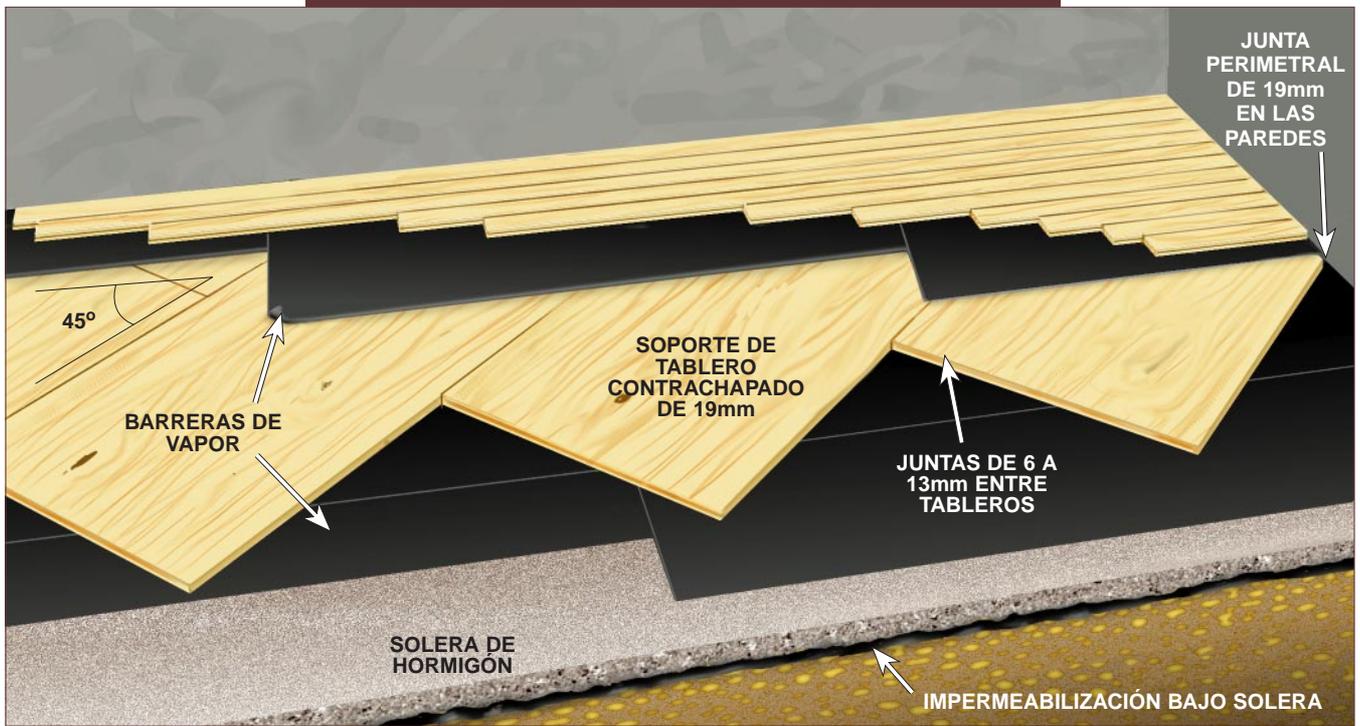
Soporte de Tablero Contrachapado Sobre Solera de Hormigón
